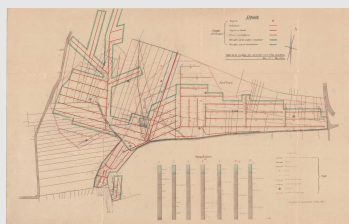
plan des drainages Haut-Vully (≈ 1930)
